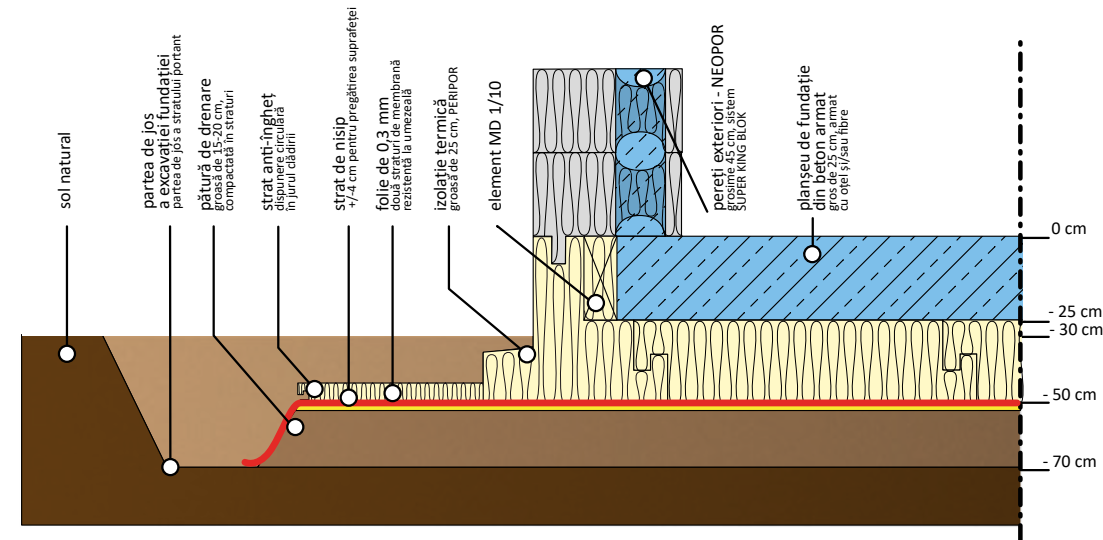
Construcție schematică a fundației cu planșeu cu ziduri exterioare groase de 45 cm (Super King Blok)
